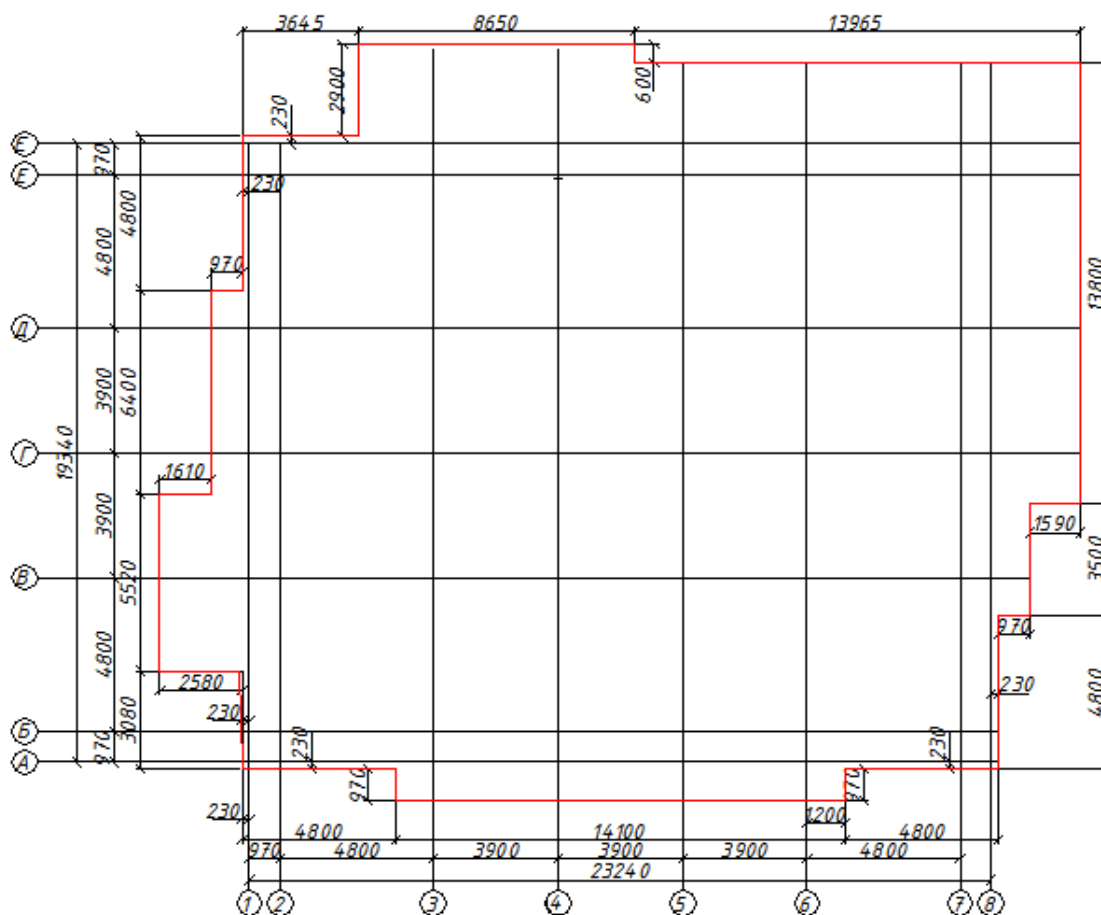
Монолітна залізобетонна фундаментна плита
